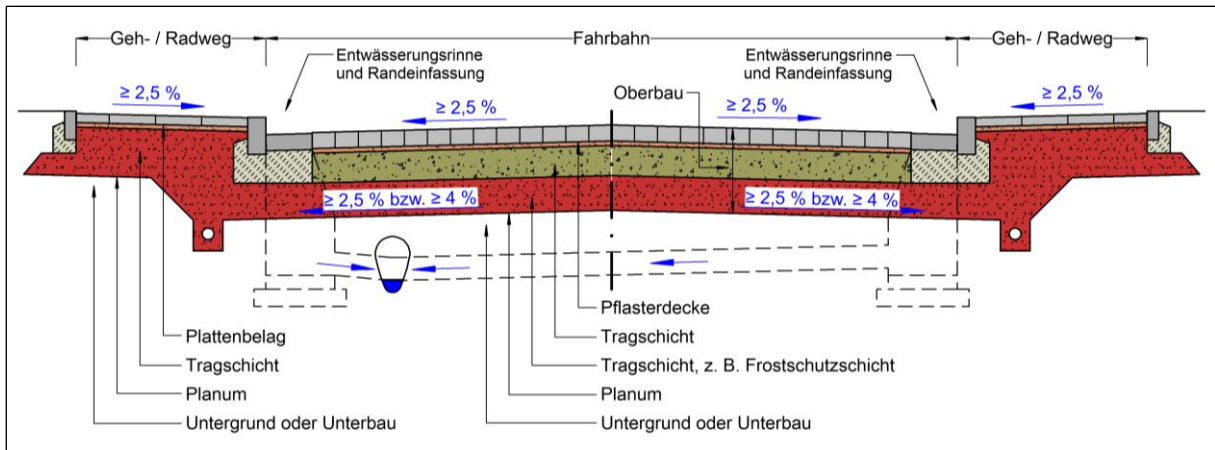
Beispielhafter Aufbau einer Verkehrsflächenbefestigung mit Pflasterdecke in geschlossener Ortslage mit Entwässerungseinrichtungen in Anlehnung an die RStO (Zeichnung: SLG)
